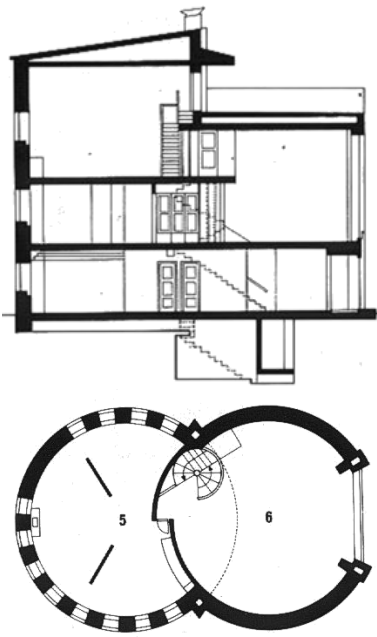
Sección y segunda planta de la Casa Mélnikov
